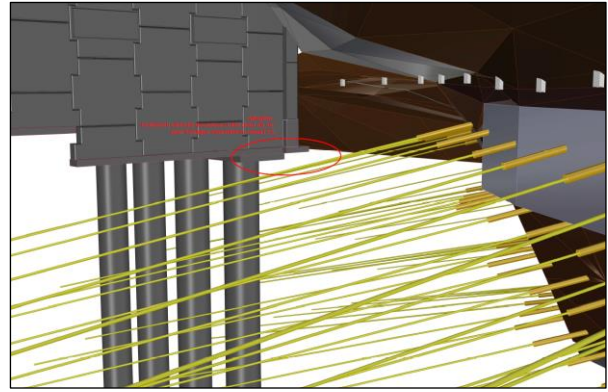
Inclinaison des clous permettant d'éviter les fondations du mur en Terre Armée et la fondation profonde de la culée
